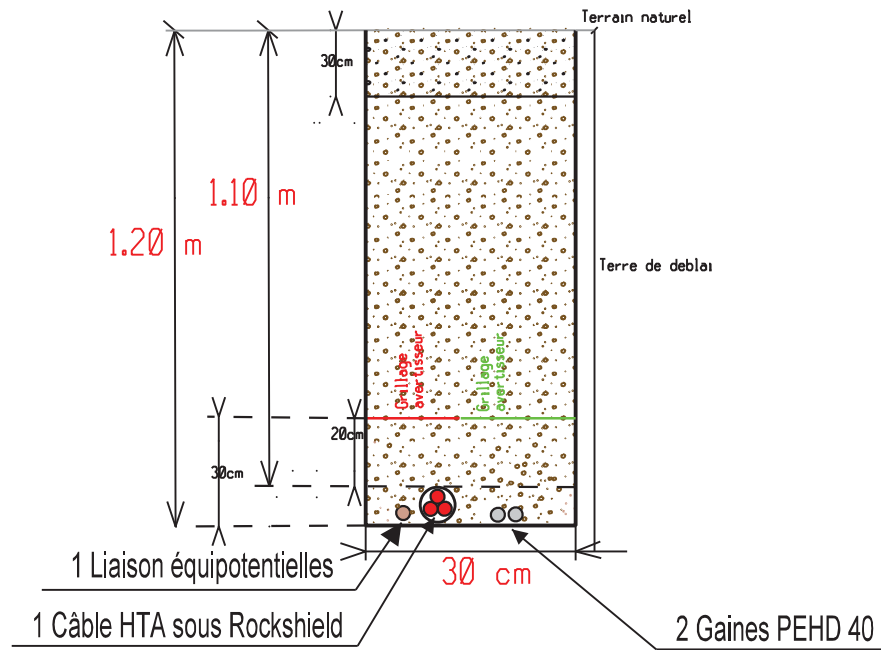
Coupe de câblage - Traversée en plein champs (1 câble)
